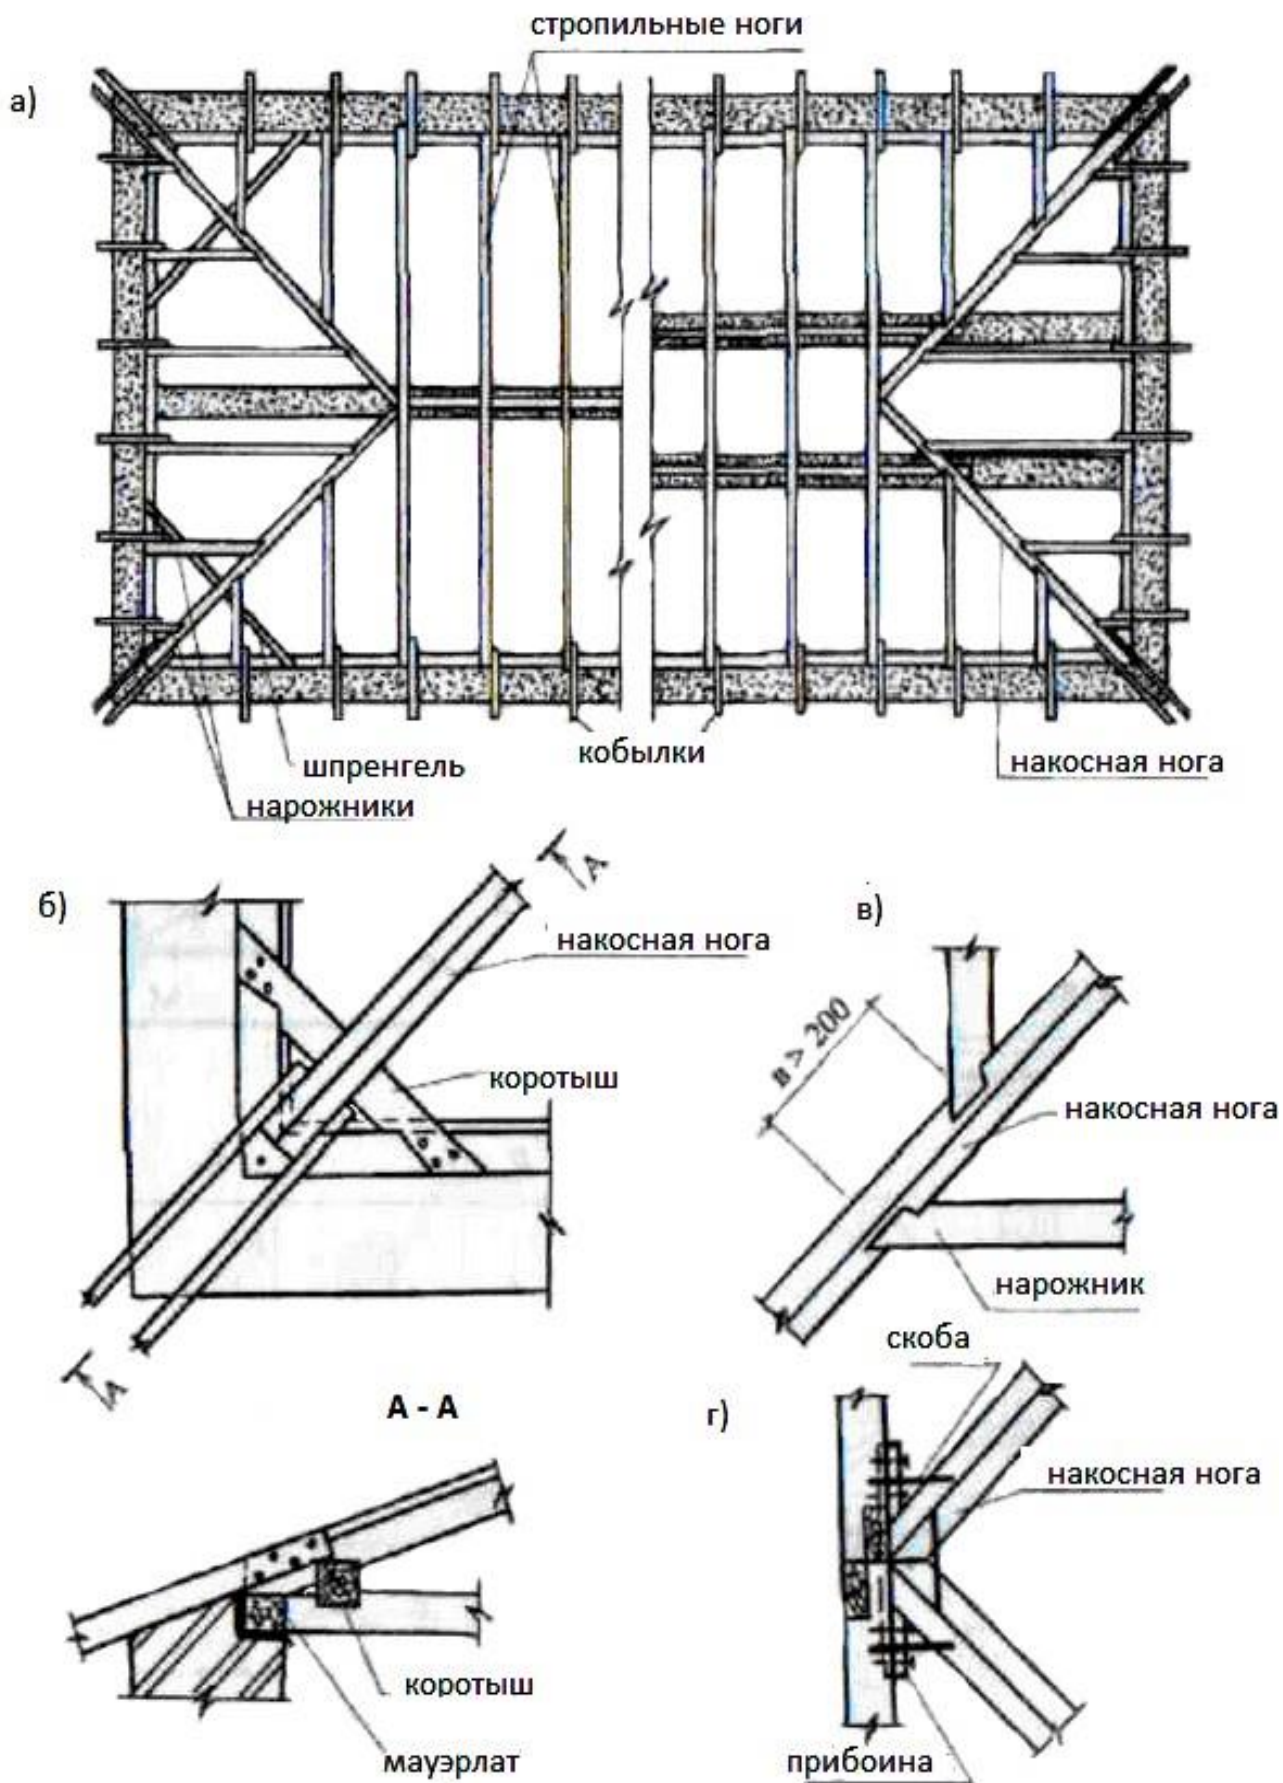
План стропил (а) четырехскатной крыши с узлами (б, в, г) и сечением (А-А)
